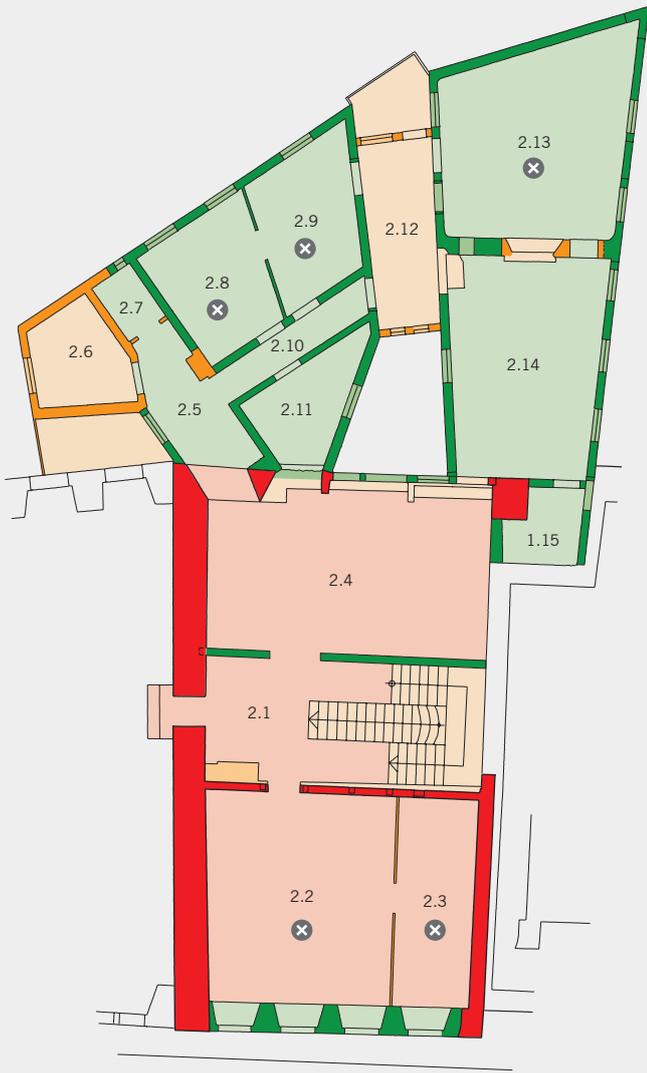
Zug, Ägeristrasse 9, Grundriss des zweiten Vollgeschosses.
